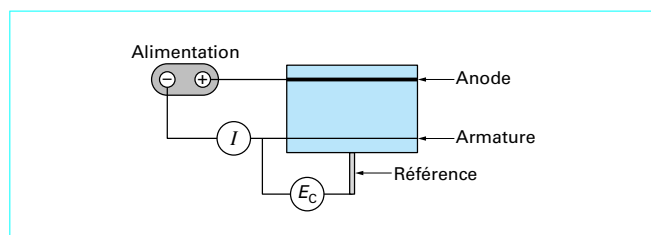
Principe de la protection cathodique des armatures dans le béton
